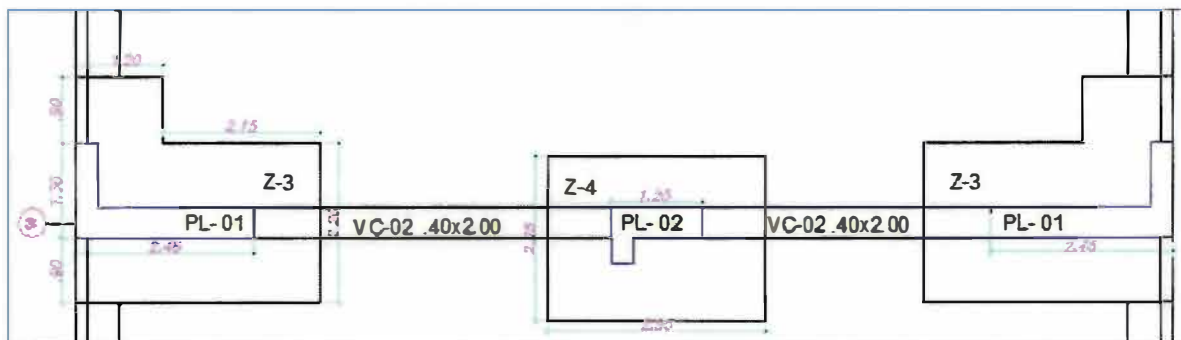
Modelo de las zapata PL-01 y PL-02 conectadas por viga.
